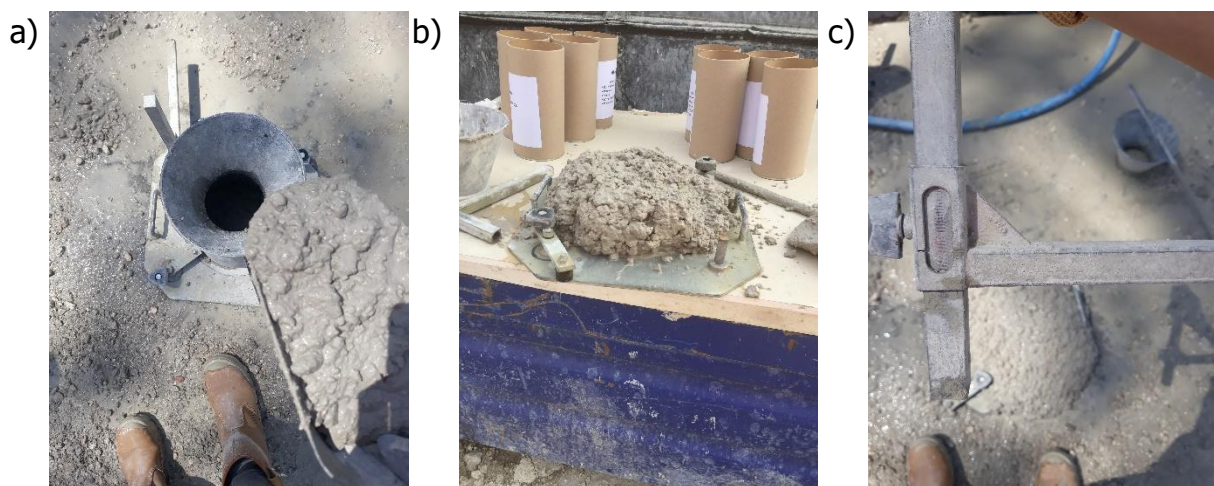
Ensaio do Slump: a) Realização do ensaio colocando o 5 pás de betão no cone; b) 9 provetes para testes de qualidade do betão a enviar ao laboratório; c) Medição do resultado do ensaio=21cm
